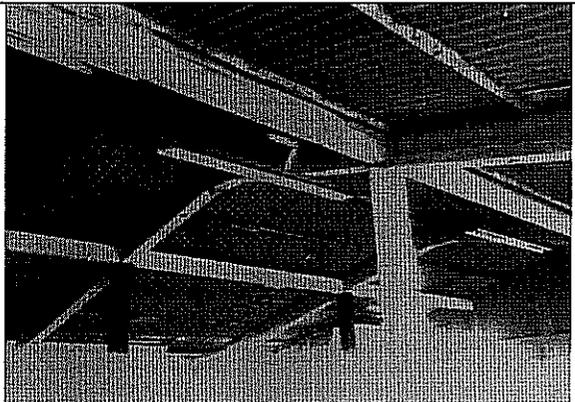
Columnas y vigas de cubierta de la edificación del costado sur en buenas condiciones.
